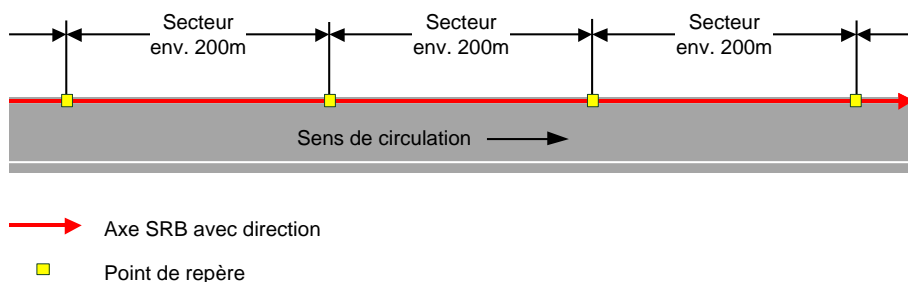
Position de l'axe sur une chaussée à sens unique.
